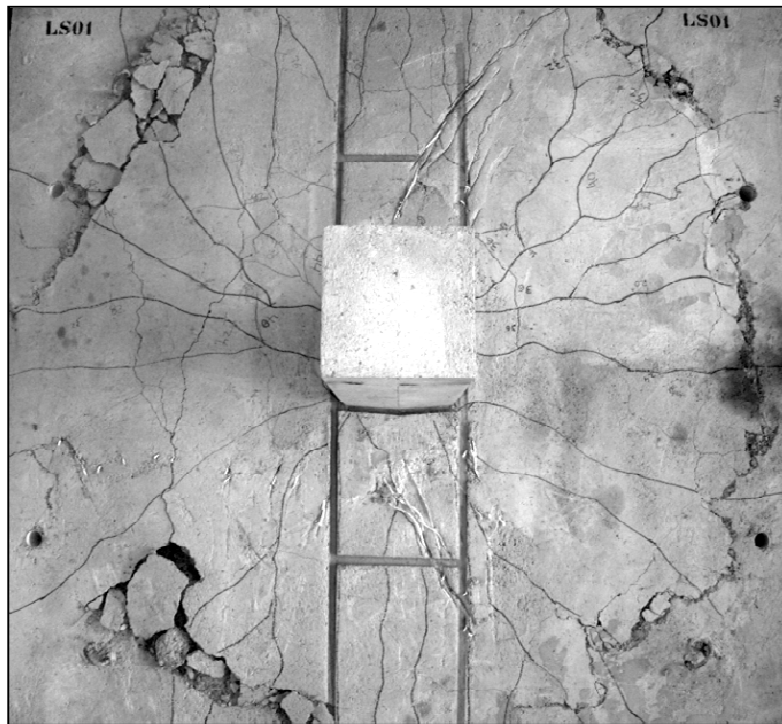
Mapa de fissuração da laje LS01
